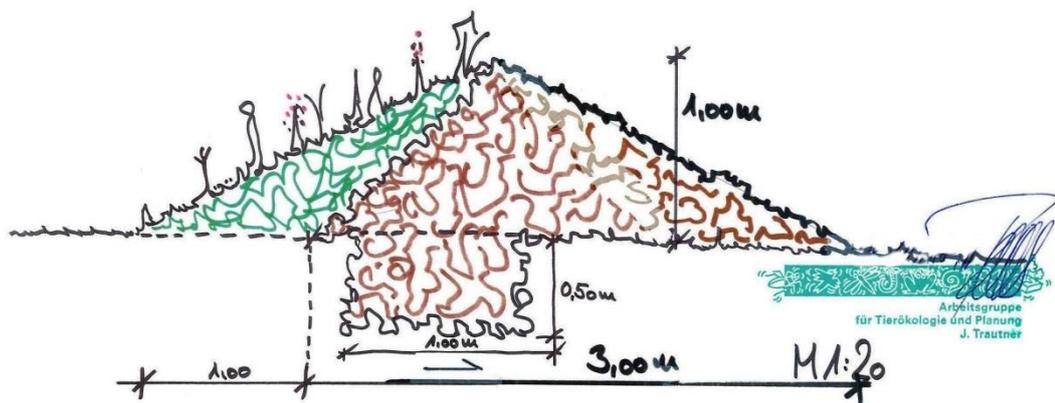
Schnitt B' - B' durch den vorgesehenen Steinwall (Skizze).
